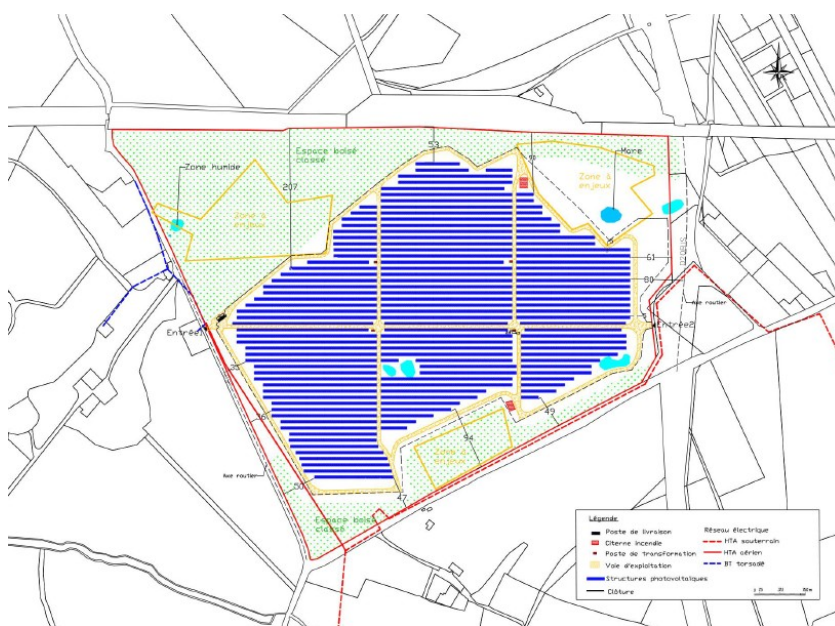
Plan d’implantation général retenu (source étude d’impact, page 30 section 2)
